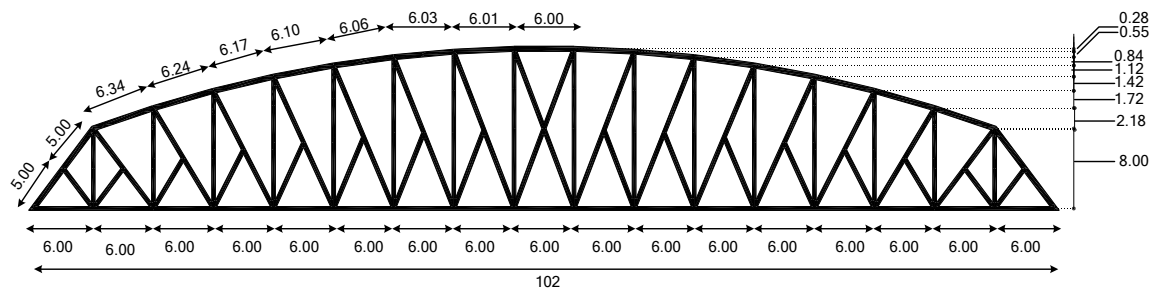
Armadura lateral del claro primero y sexto del puente Pinzandarán
